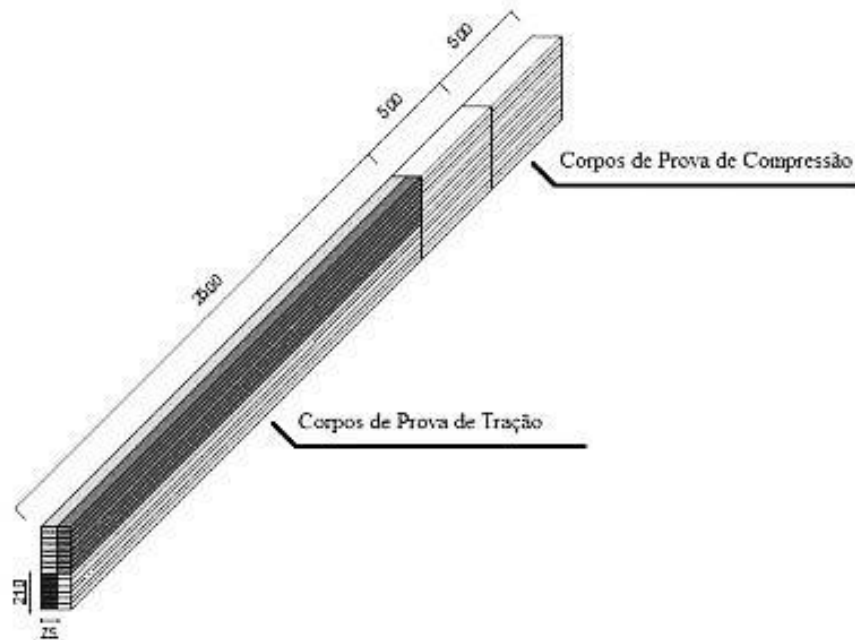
Layout da extração de corpos de prova dos elementos (dimensões em mm).
